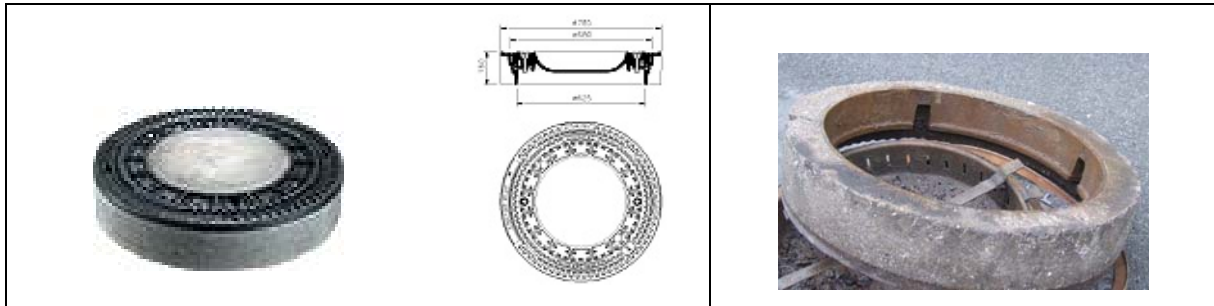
Schachtabdeckung mit Beton-Guss-Rahmen [24]
